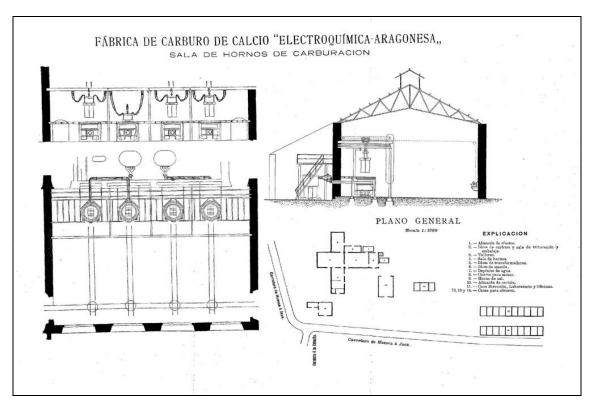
Plano de la fábrica (Estadística Minera, 1907)
